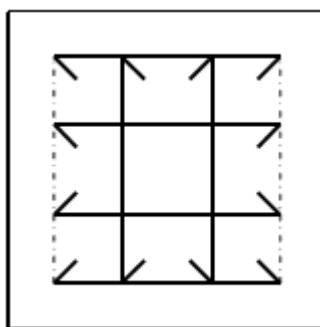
Ferrailage du dé d'appui – vue en plan.
